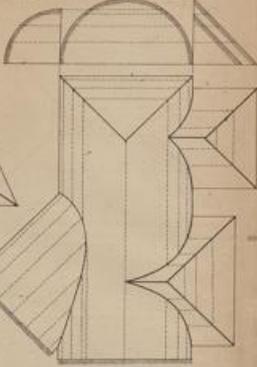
Der Kammort in einer windschiefen Dachung durch ein Profil ermittelt.
